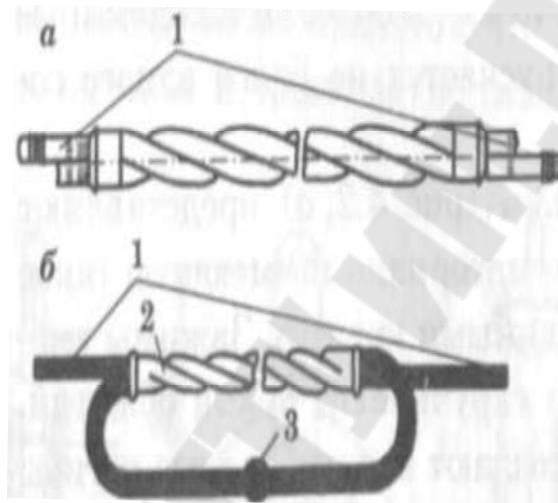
Соединение проводов скручиванием овального соединительного зажима (а) и термитной сваркой (б): 1 – концы проводов; 2 – соединитель; 3 – место сварки проводов
